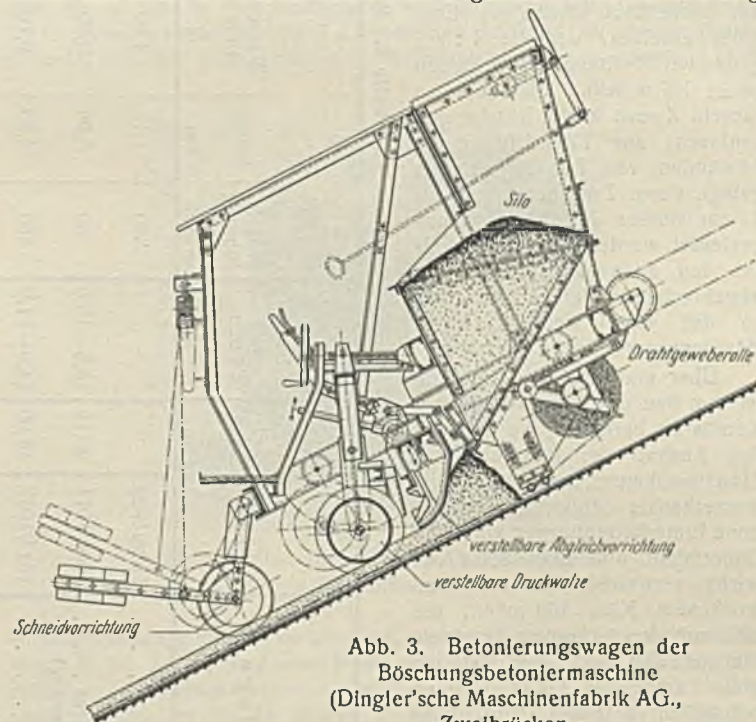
Betonierungswagen der Böschungsbetoniermaschine (Dingler'sche Maschinenfabrik AG., Zweibrücken).
